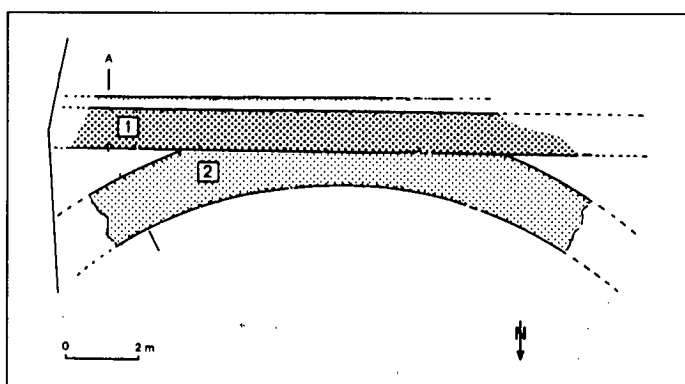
ARLES, Rue du Sauvage. Plan. En A, emplacement de la coupe présentée en fig. 20.
